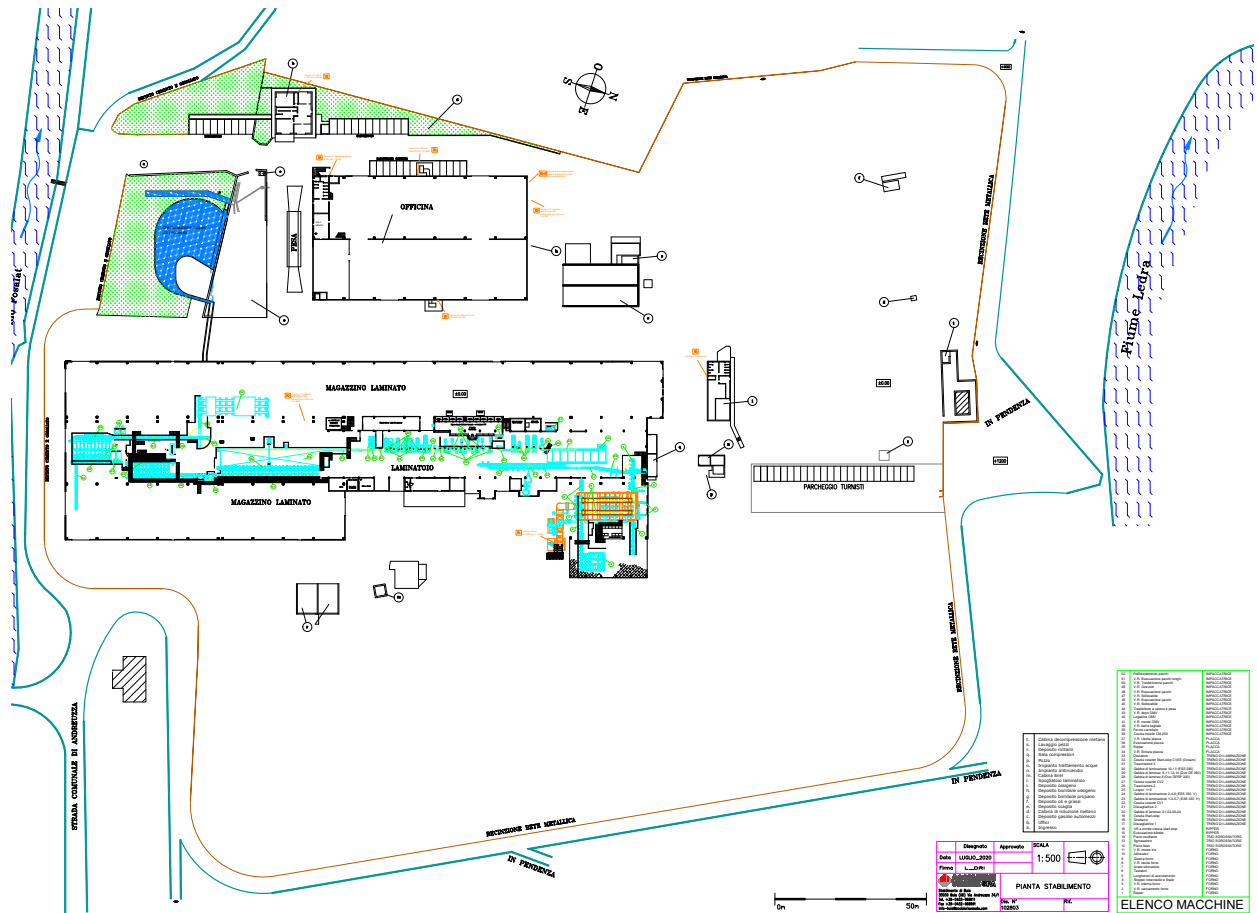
Planimetria del sito Acciaierie Venete S.p.A. di Buja
